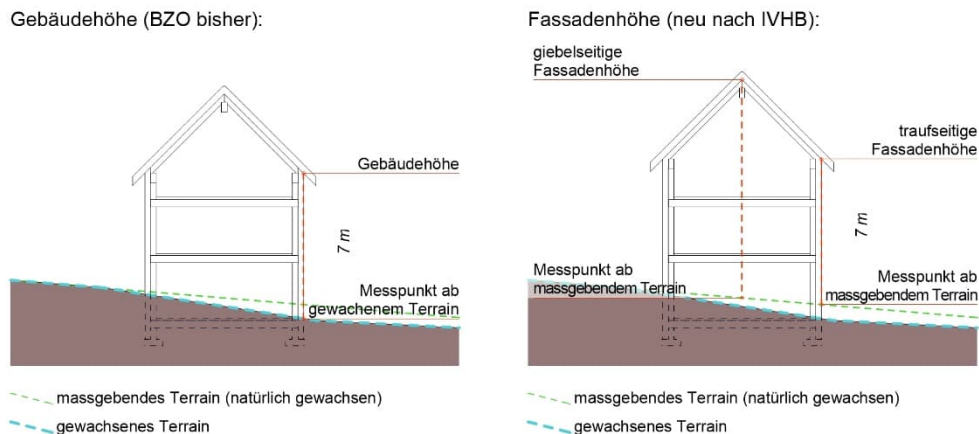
Vergleich Gebäudehöhe und Fassadenhöhe (Eigene Darstellung, 2024)
